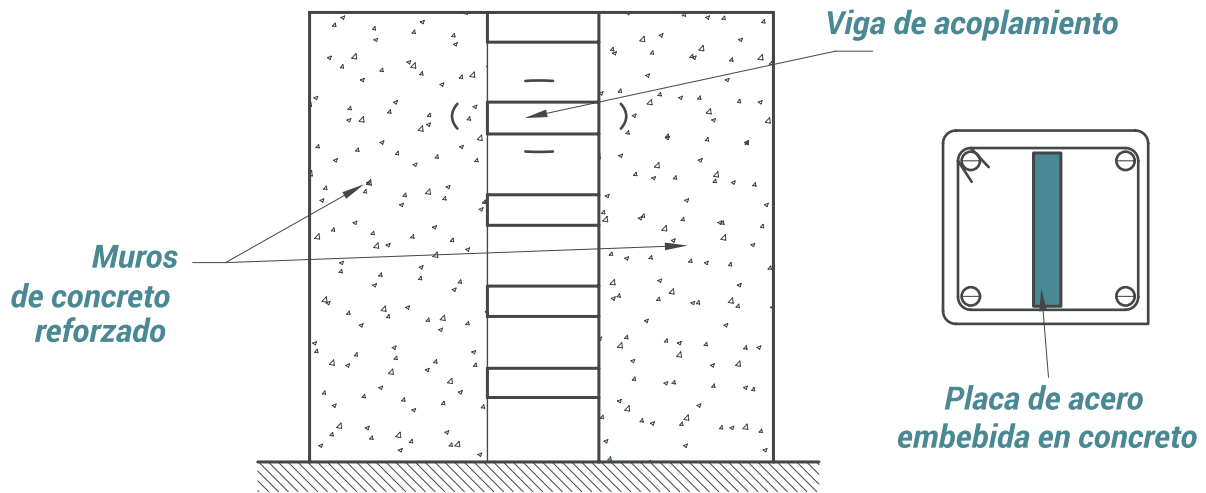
Muros de concreto reforzado con vigas acopladas compuestas.
